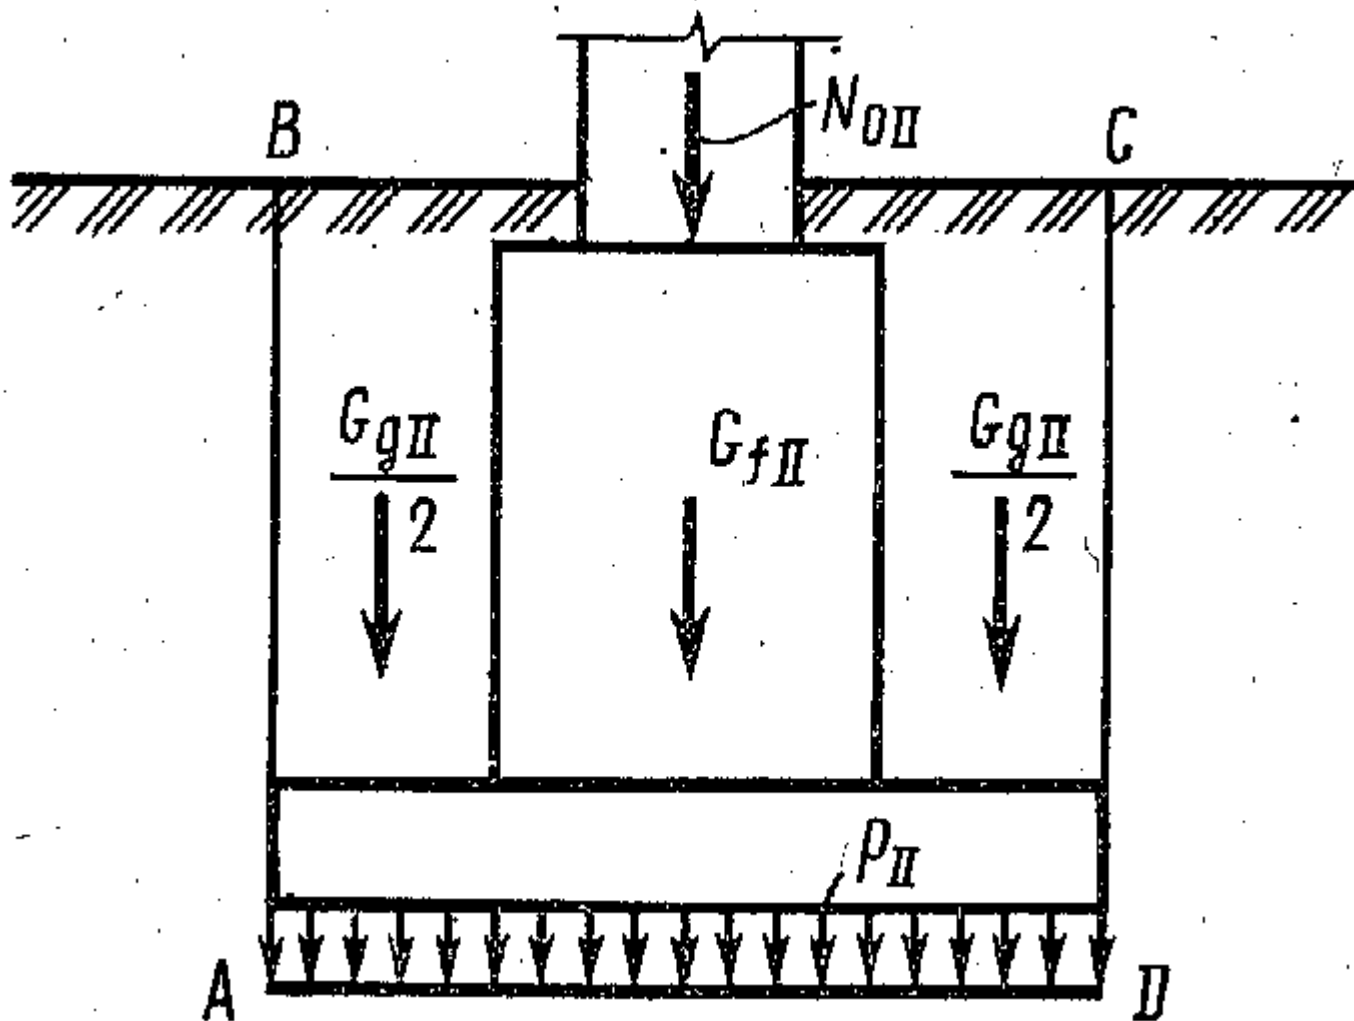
Расчетная схема центрально нагруженного фундамента
